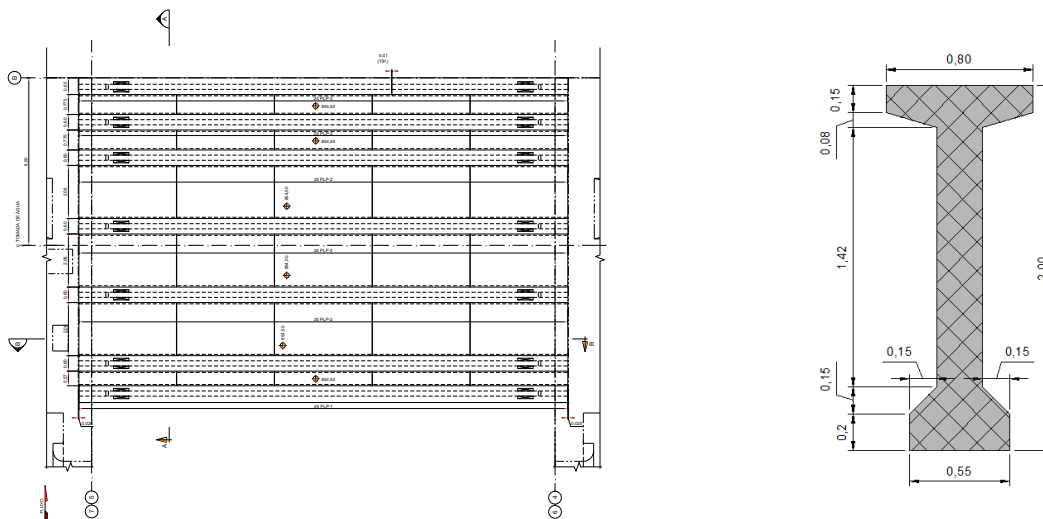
Proyecto básico- Puente de acceso – Planta y sección de viga premoldeada (Intertechne, 2014)
